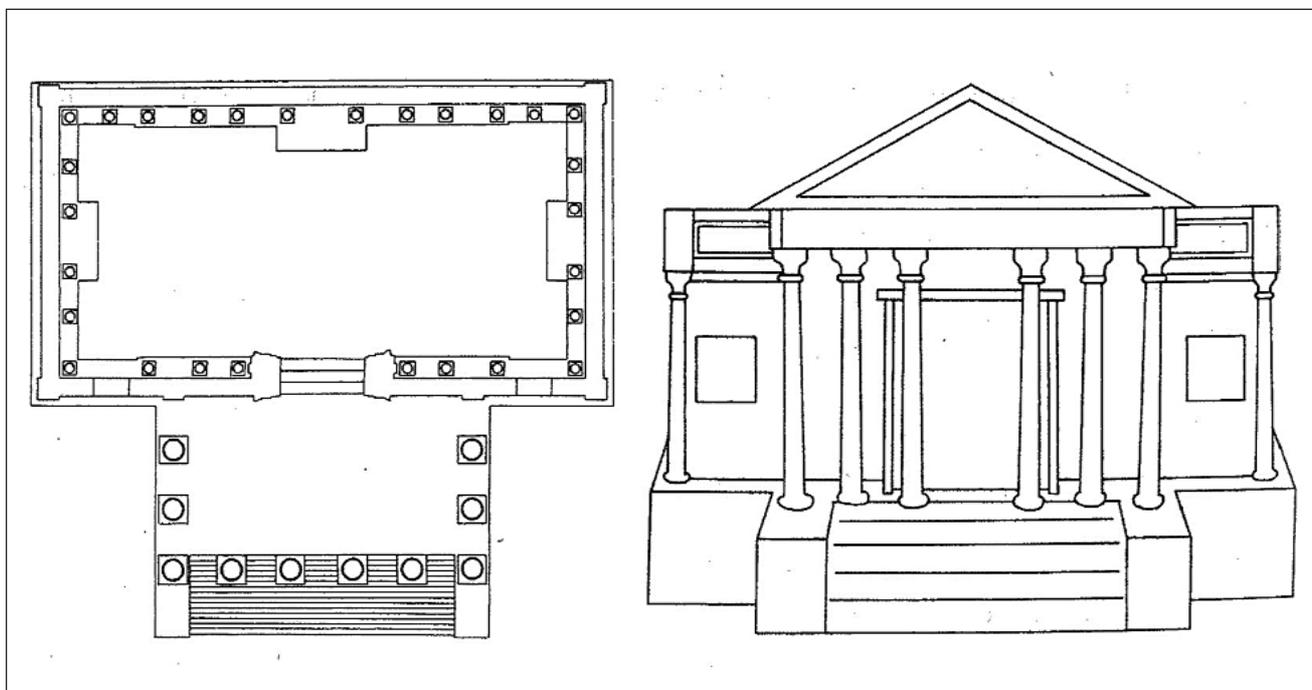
Reconstrucción de la planta y alzado del templo de la Concordia de Roma.
